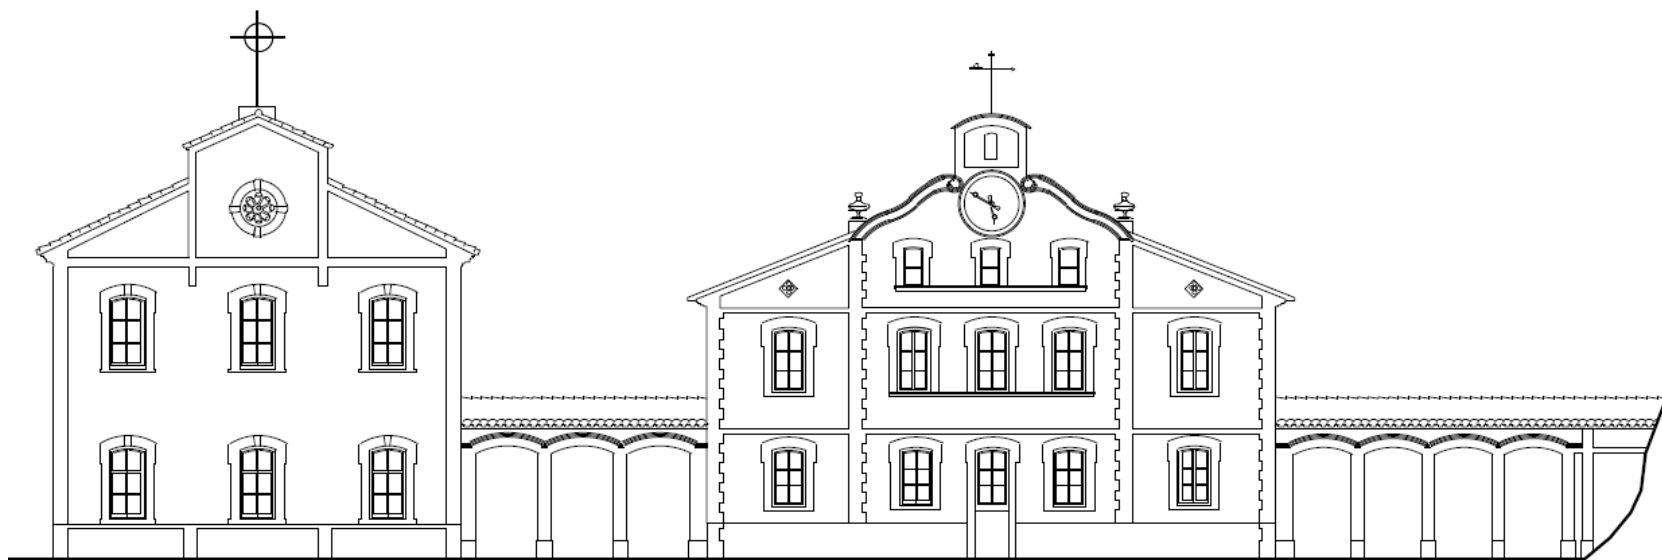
Levantamiento planimétrico de las fachadas del Pabellón Central y Pabellón de La Purísima. Periodo década 1910-1940. Orientación Sur.
